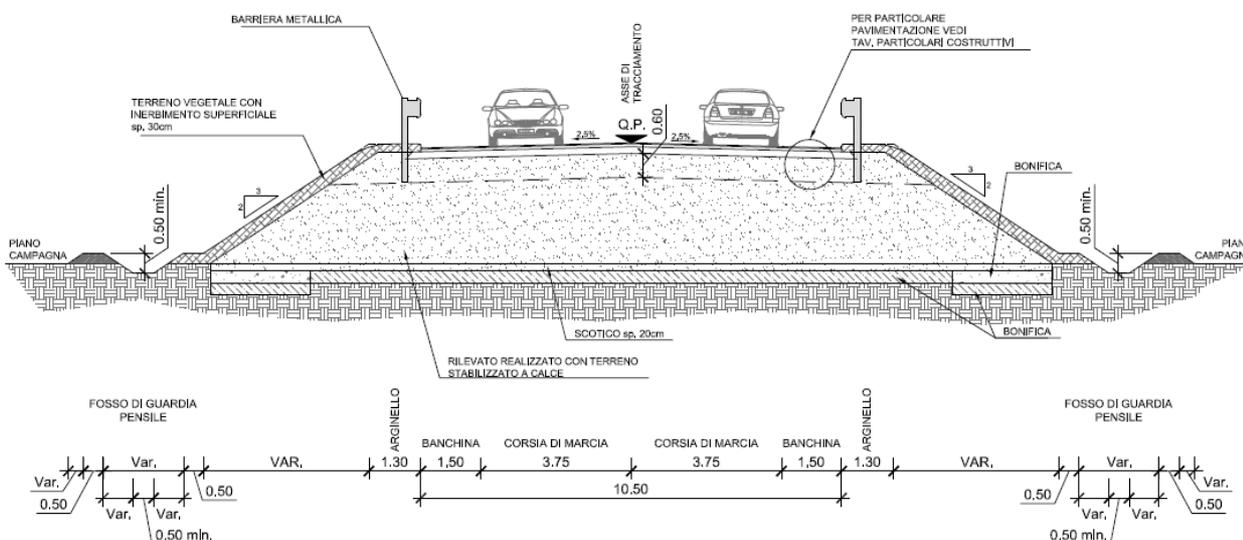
SEZIONE TIPO IN RETTIFILO
